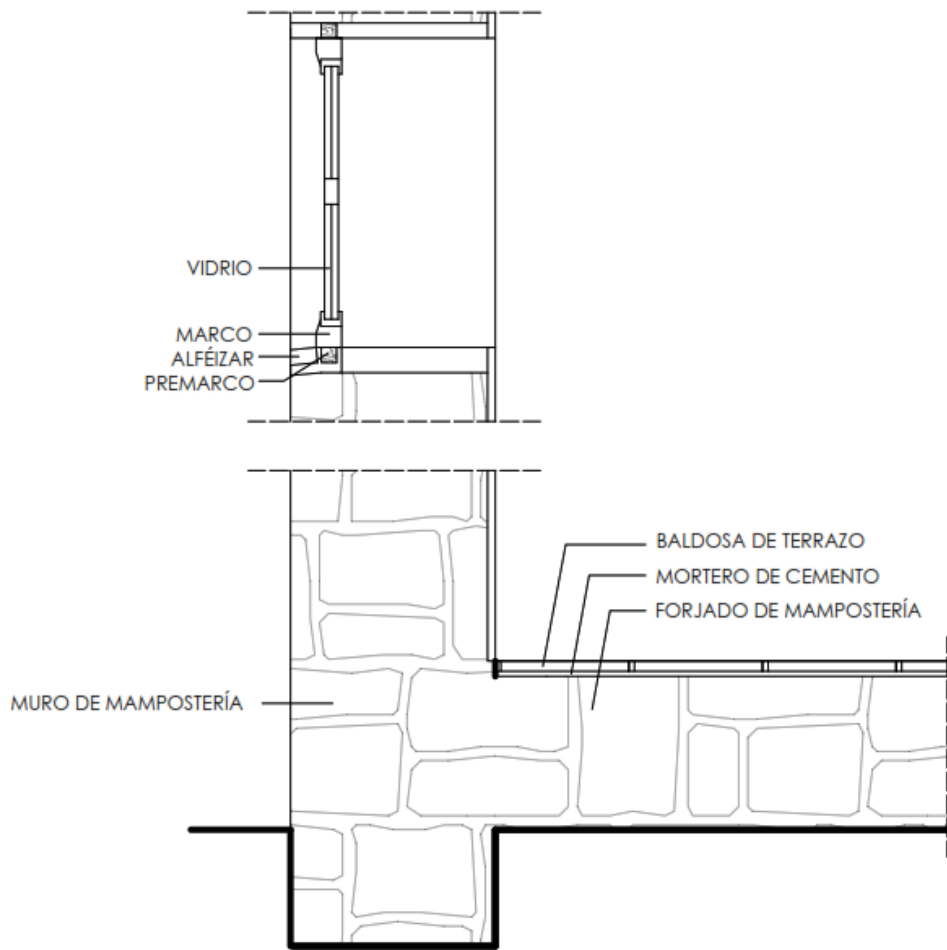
Ermita: muro en contacto con el terreno y encuentro del muro con la carpintería.
